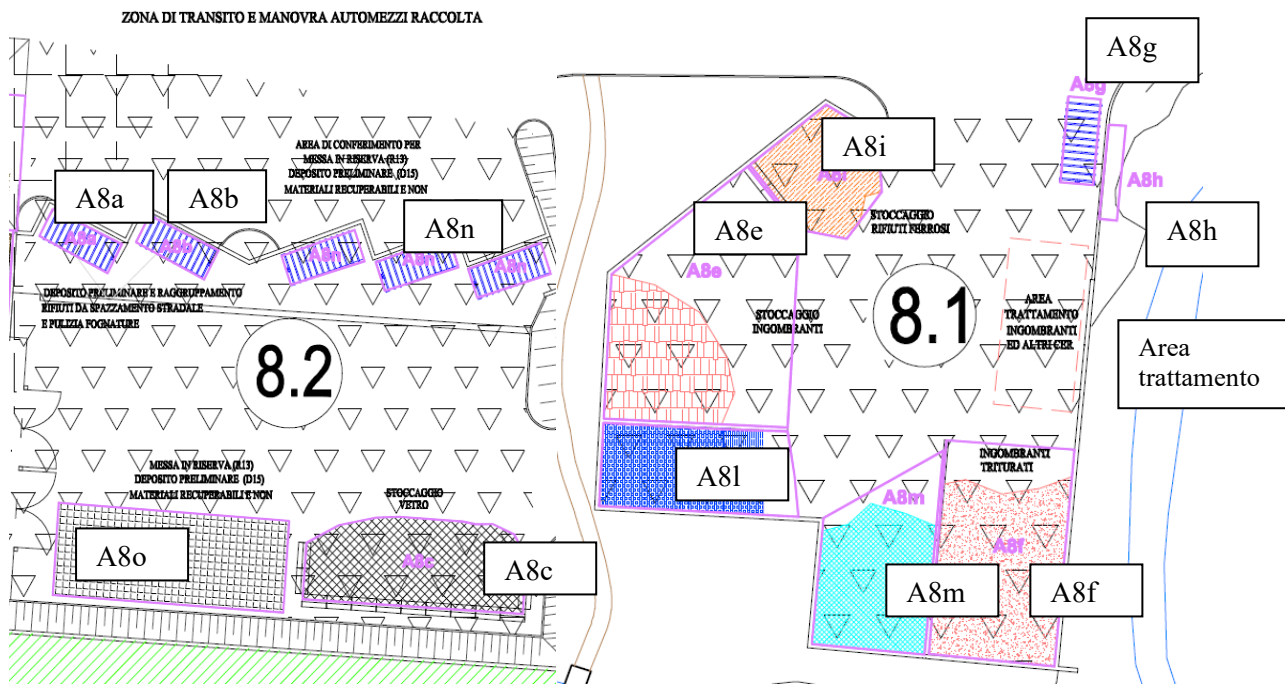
Estratto da Tavola V “Planimetria generale dell’impianto”. Area 8.2 e Area 8.1 Stato attuale
